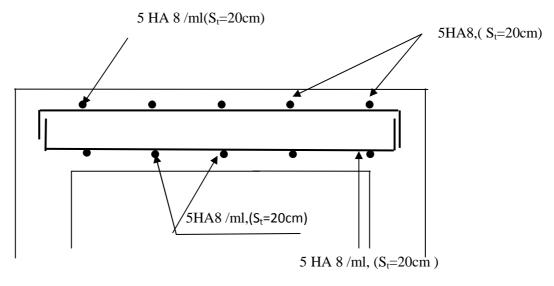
Ferraillage de la dalle pleine de la salle machine dans le sens y-y.
